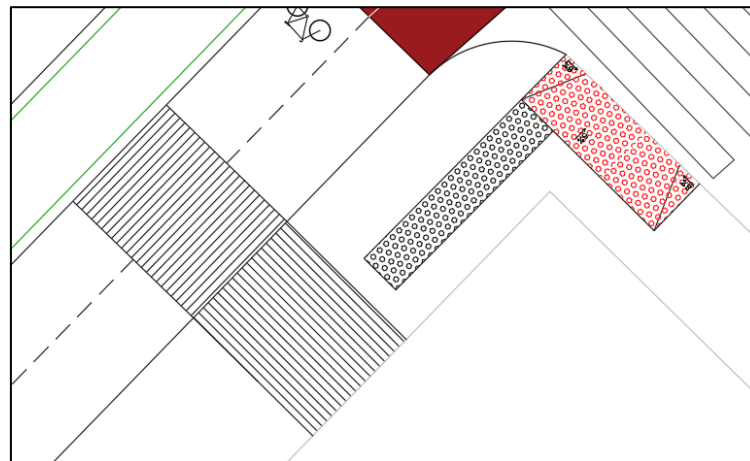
Disposición del pavimento señalizador del carril ciclista y del pavimento táctil de botones en un cruce semaforizado
